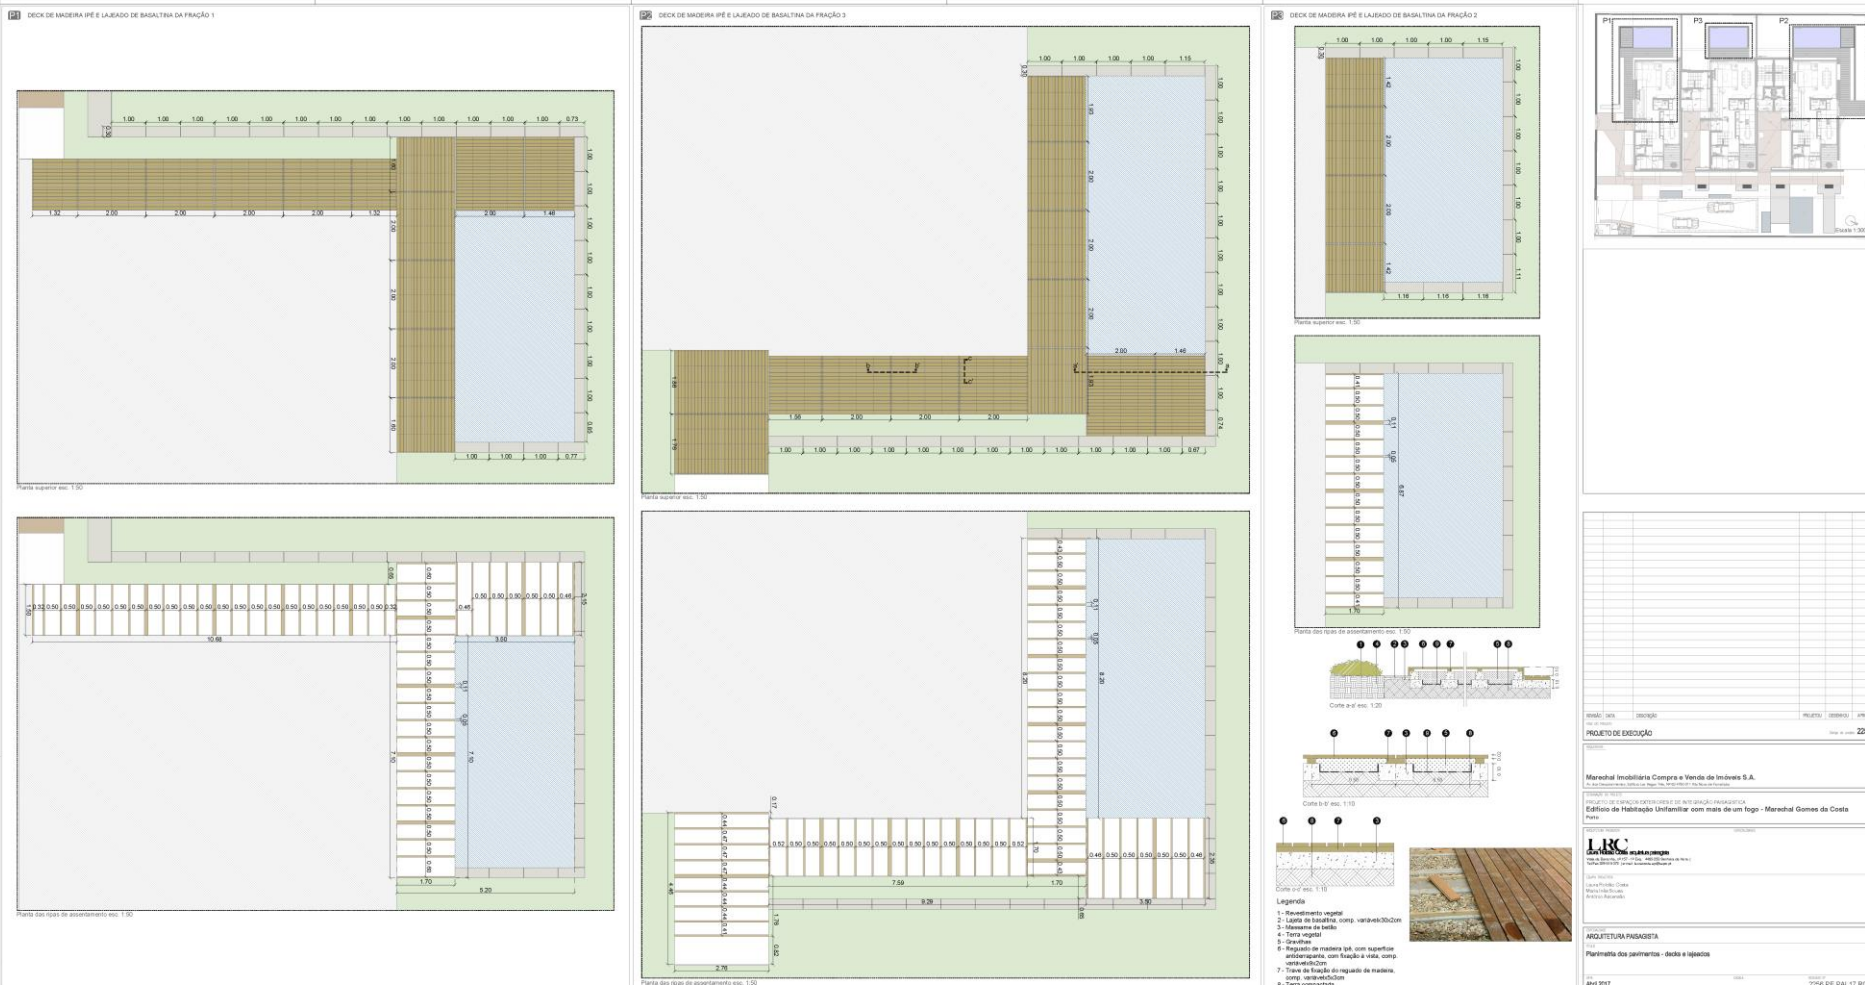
Planimetria dos pavimentos do Projeto Marechal 1000: decks e lajeados.
